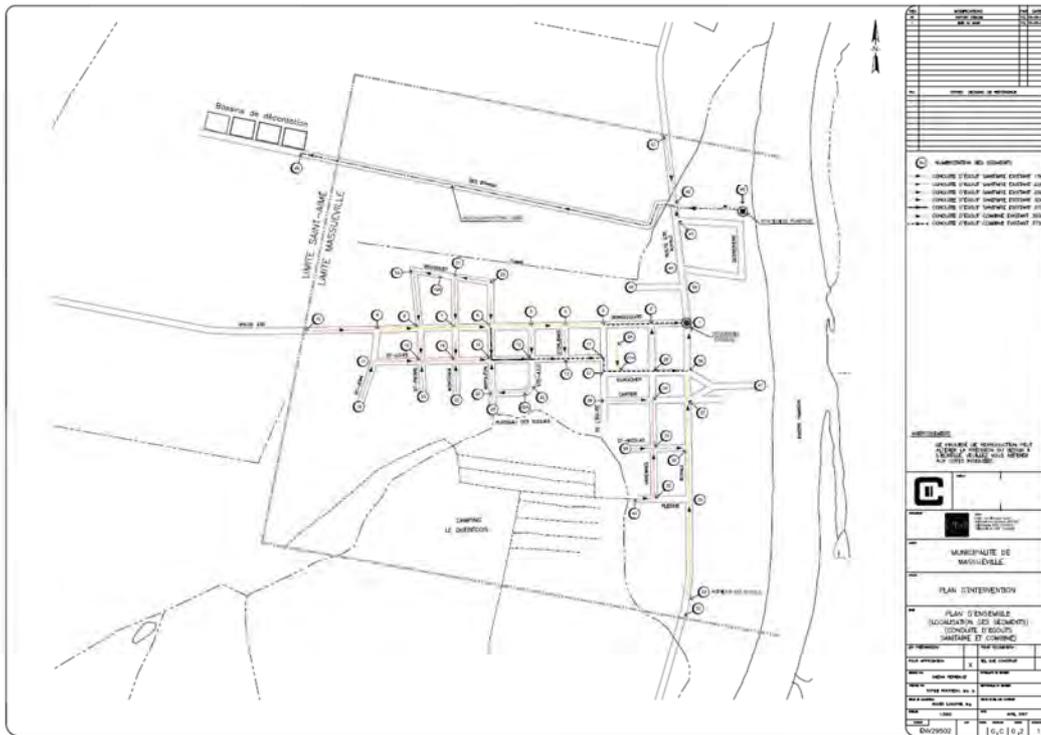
Localisation des segments – Conduite d’égouts sanitaire et combiné
